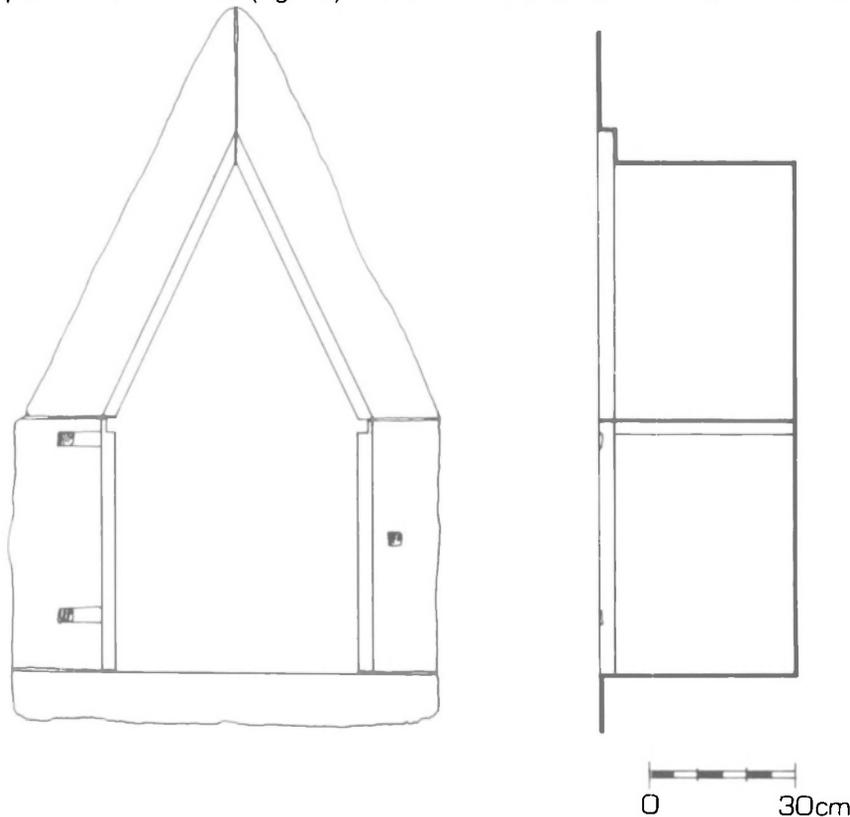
Spontin. Élévation et coupe de l'armoire murale au sud du deuxième étage.
